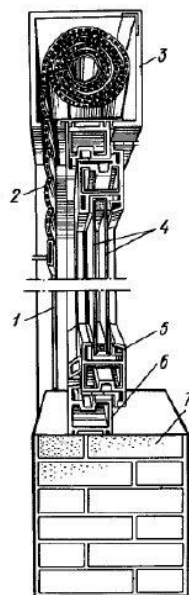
Конструкция окна из легких металлических профилей: 1 — направляющая, 2 — штора, 3 — шторный барабан, 4 — остекление, 5 — открывающаяся створка, 6 — оконная коробка, 7 — стена
